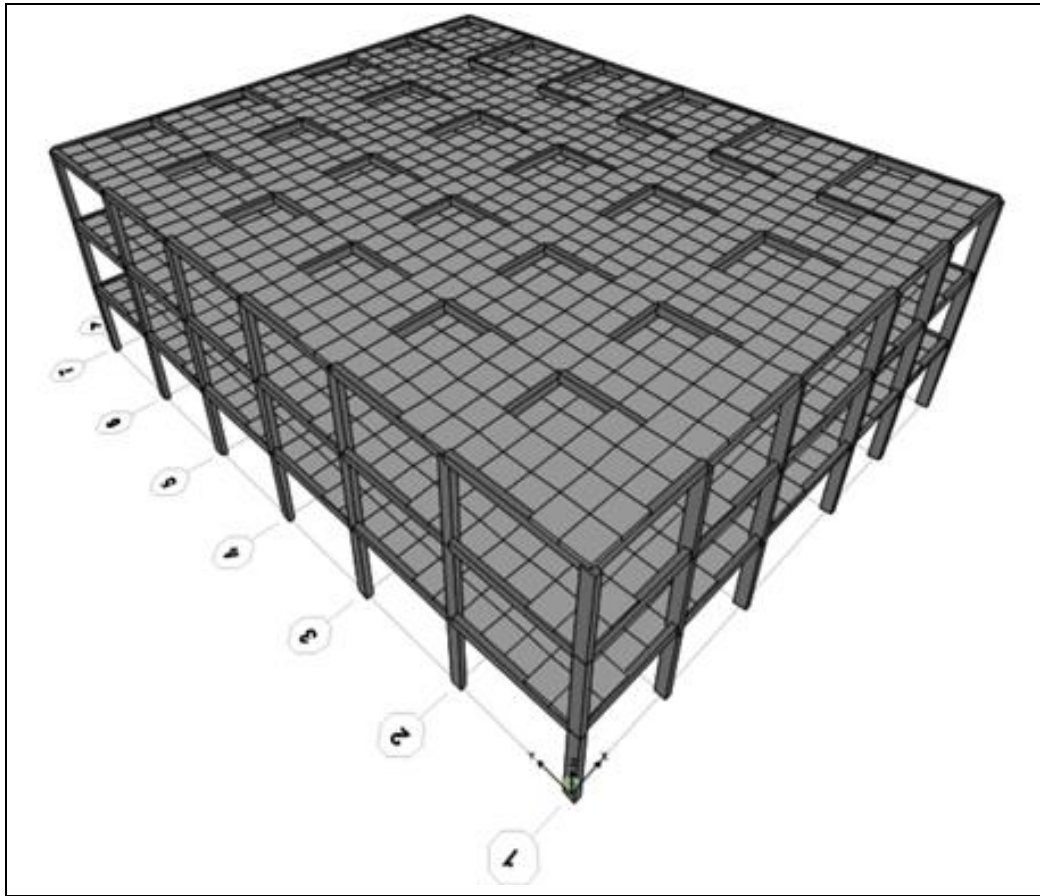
A5 Binasına ait plan görünümü ve taşıyıcı eleman bilgileri.
